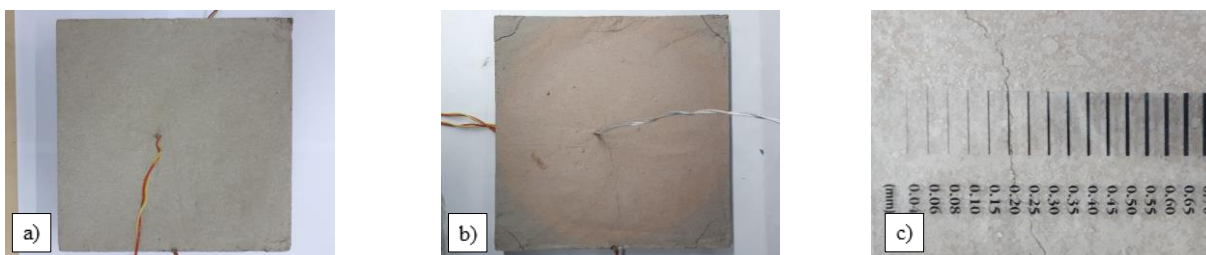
Provete P_A5_2_LA: a) Provete antes do ensaio; b) Provete após o ensaio; c) Fissuração do provete após o ensaio.
